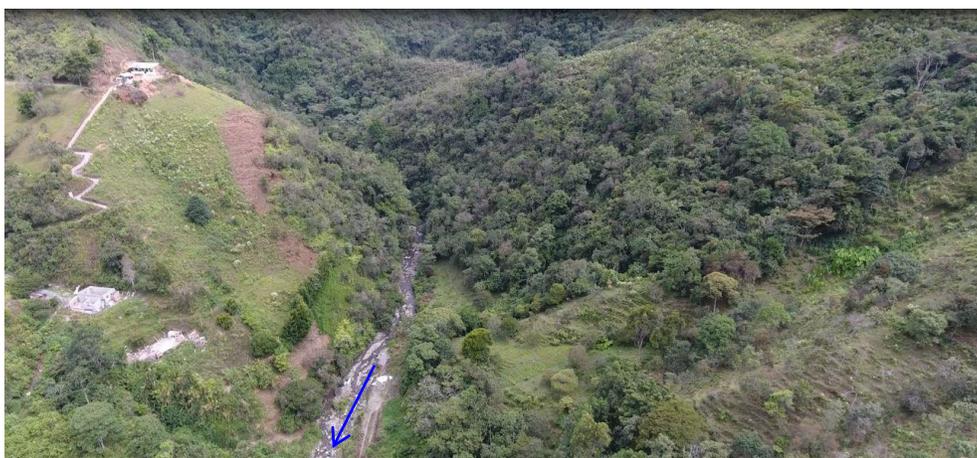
Vista de la quebrada aguas arriba del box - culvert
